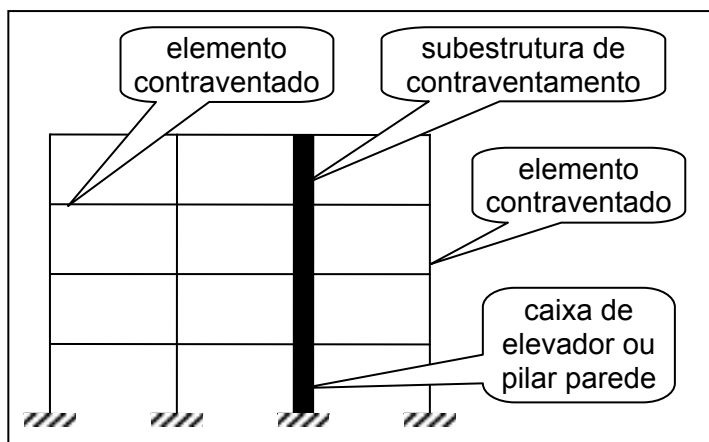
Subestruturas de contraventamento e elementos contraventados
